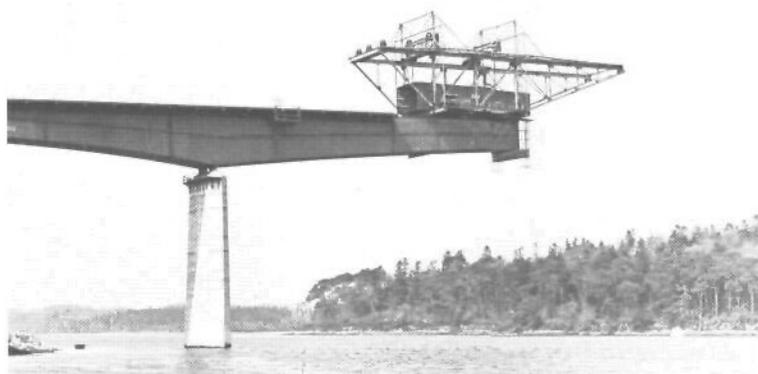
Le tronçon à mettre en œuvre passe à l'intérieur de l'appareil.
